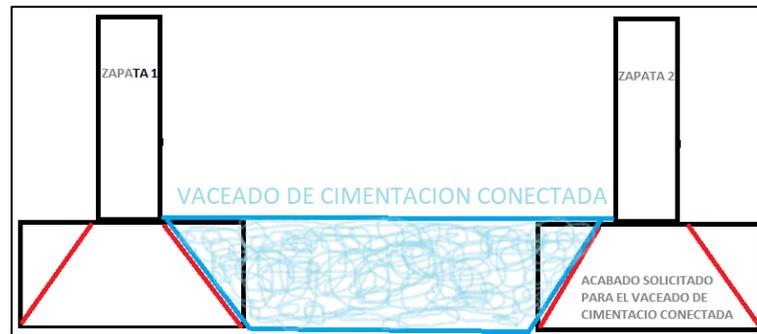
Vaceado de cimentación conectada para salvar zapatas
